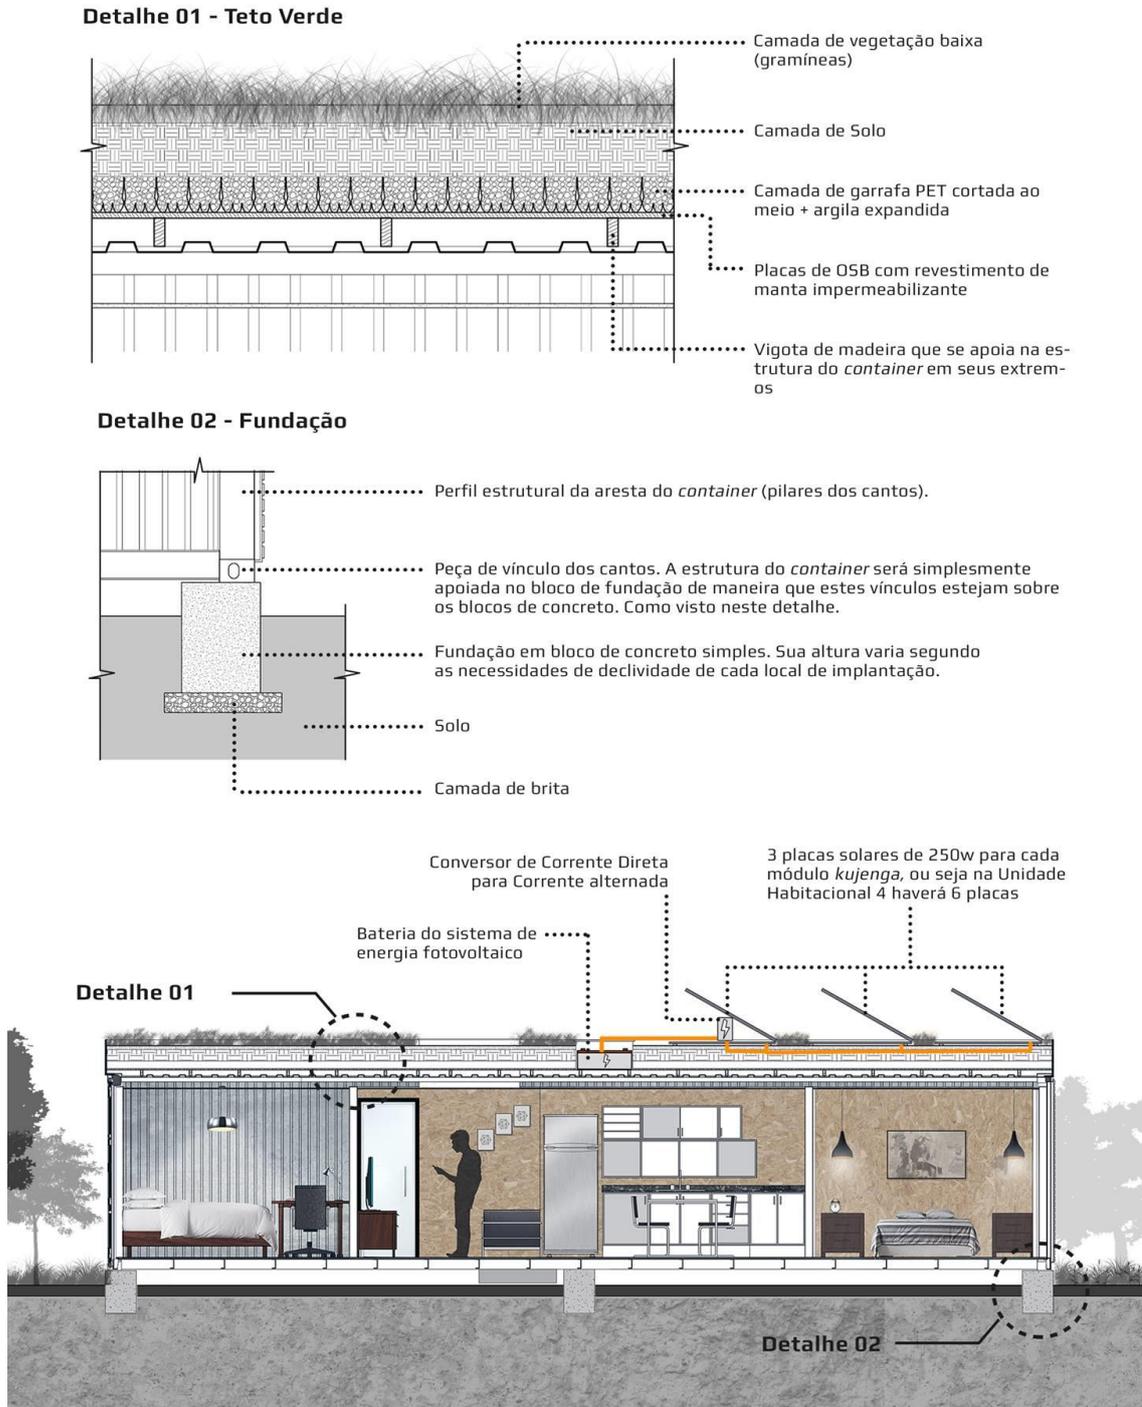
Corte Longitudinal da Unidade 4 e Detalhamento, fonte: autores, 2016.
